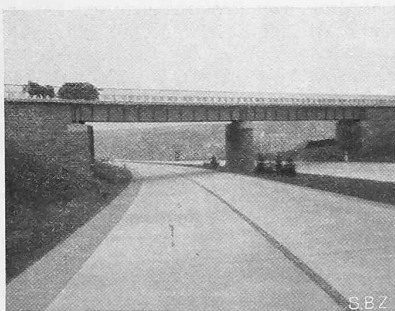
Blechbalken auf Mauerwerkpfeiler, Betonwiderlager mit Hausteinvorblendung.
